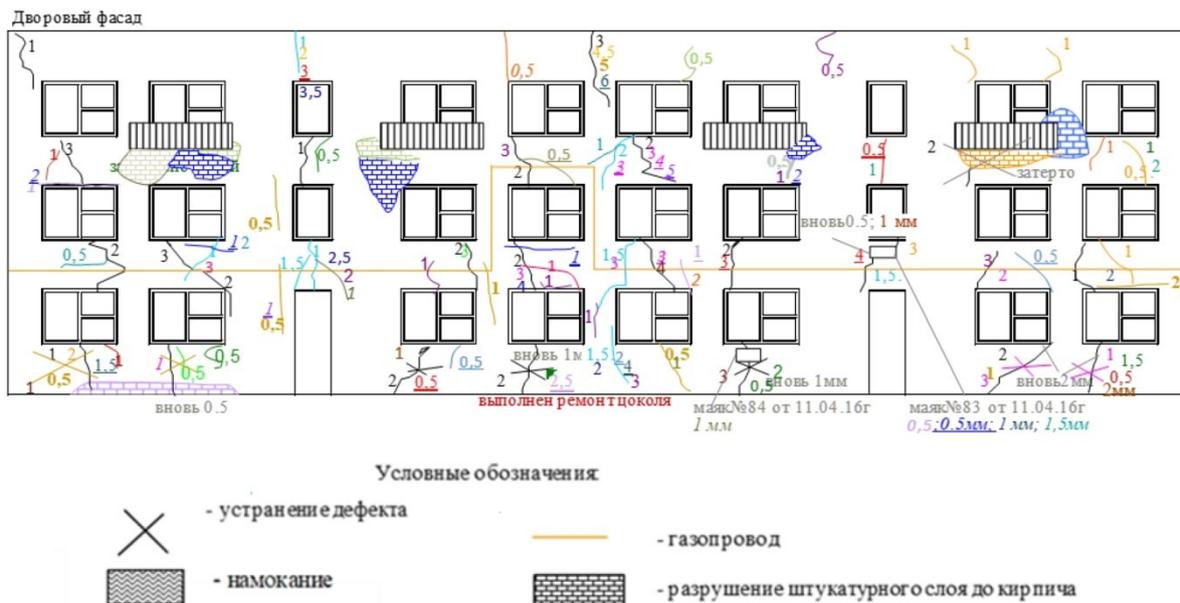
Пример эскиза фасада жилого дома с нанесенными дефектами наружных стен, выполняемого специализированной службой ПАО «Уралкалий»
